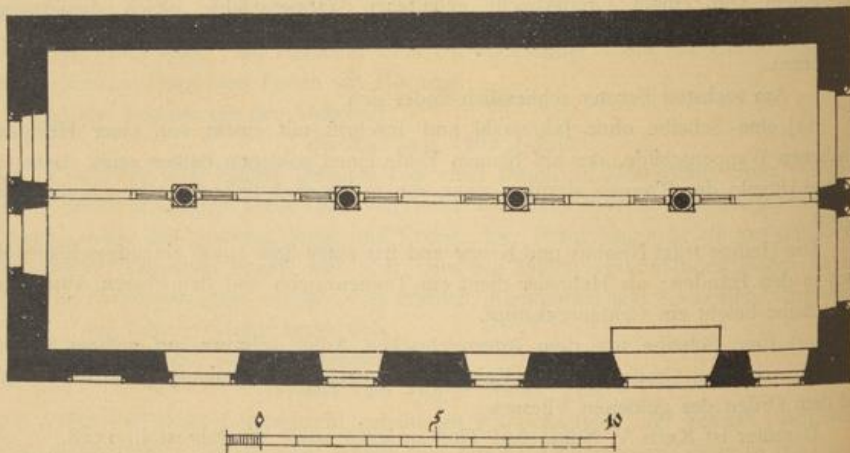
Endingen. Kaufhaus, Grundriss.
